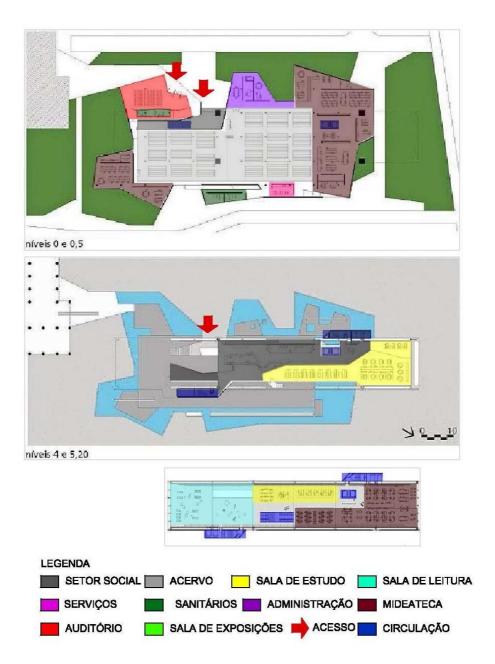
Plantas Baixas do pavimento térreo e primeiro pavimento. Fonte: SPBR, 2006.
